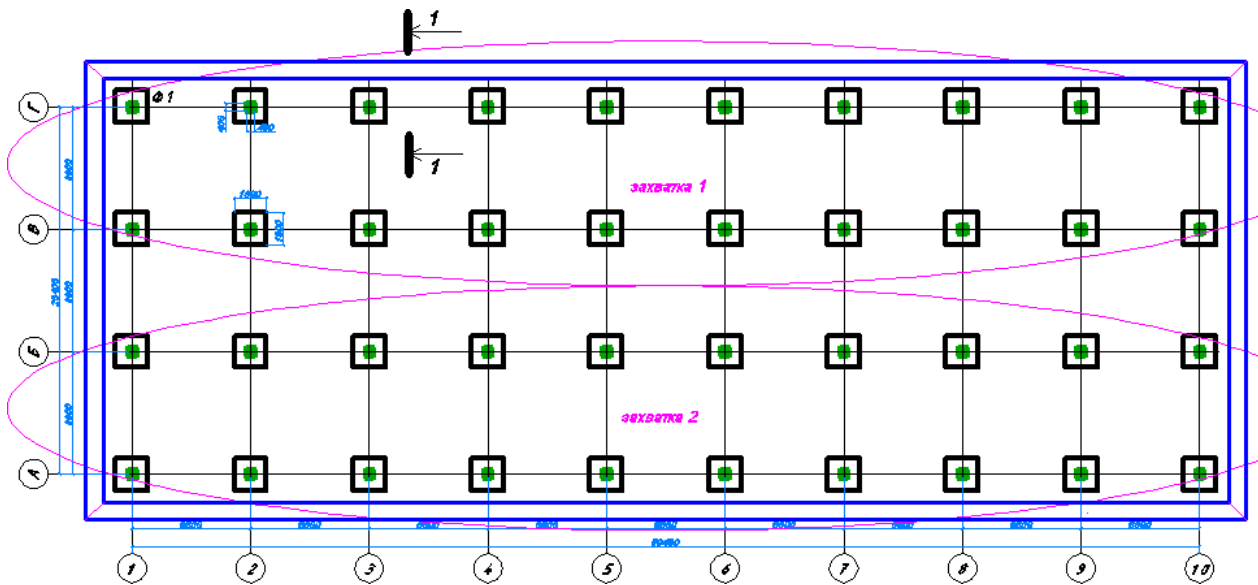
Схема розташування стовпчастих фундаментів в котловані.
